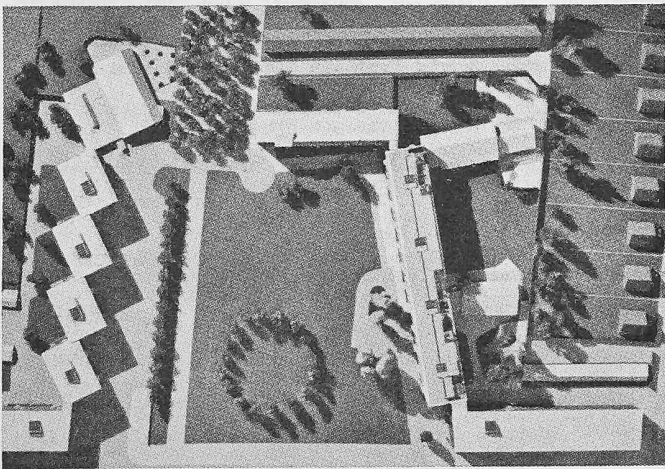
Hoje Soborg, Modellphoto des Kollektivhauses. Hauptbau mit Laubenganghaus, unten rechts Bürotrakt, oben rechts Säuglingsheim und Kindergarten.
